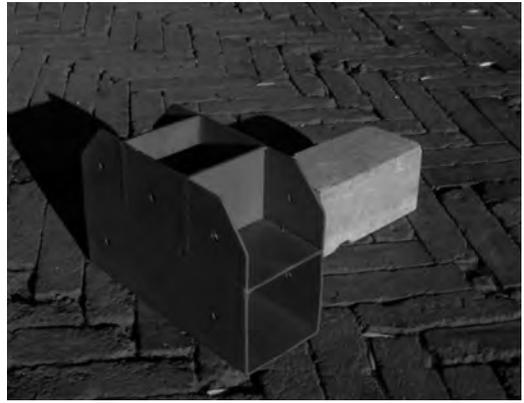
Fotografía de una conexión real empleada en la construcción del puente.
